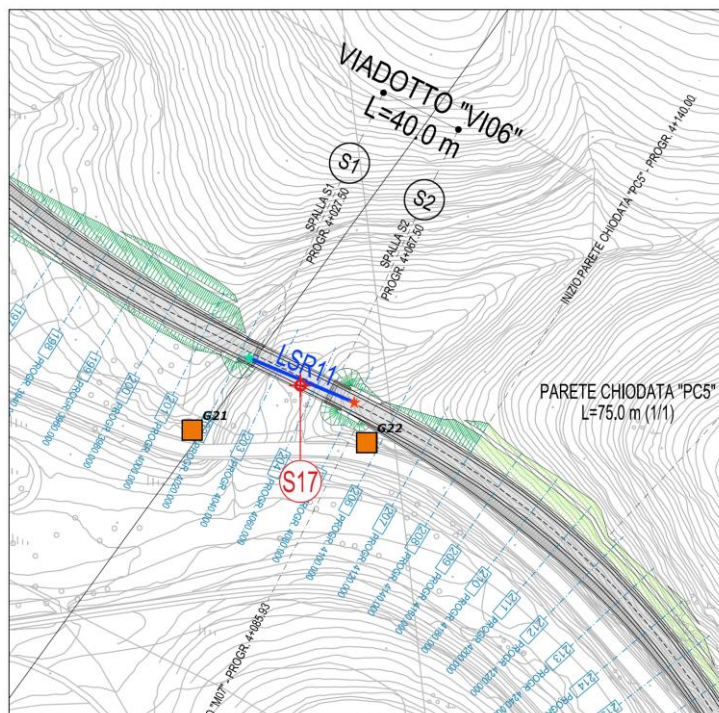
Viadotto VI06, stralcio planimetrico con ubicazione indagini geostatiche effettuate.
